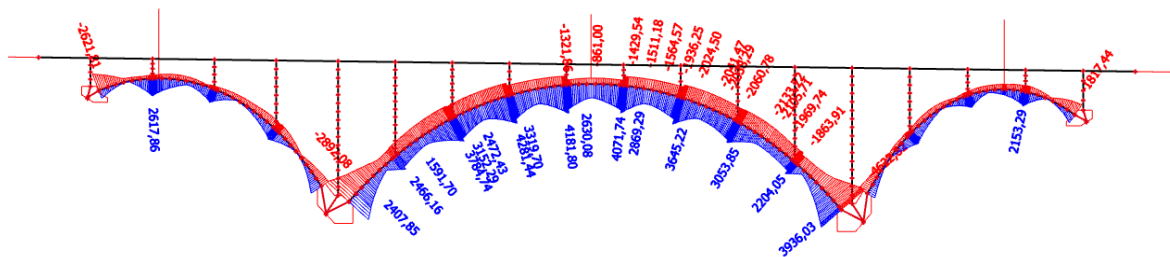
Průběh posouvajících sil na oblouku [kN]
